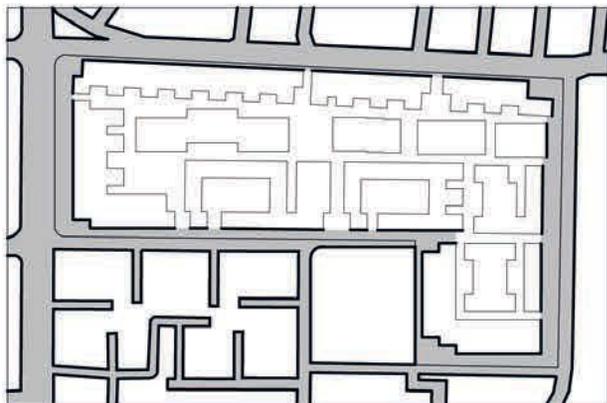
Plano Proyecto Urbano Agrupación Previ
